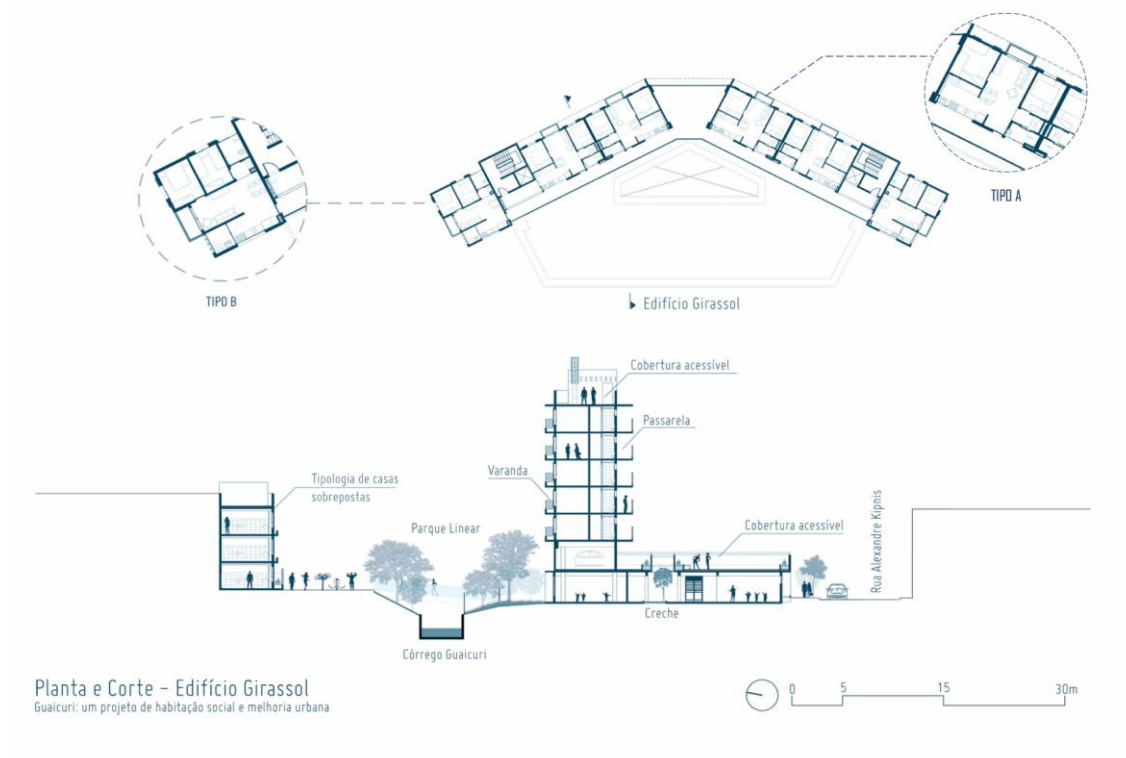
Planta do Pavimento Tipo e detalhe de unidades habitacionais “Tipo A” e “Tipo B” do Edifício Girassol (acima); Corte esquemático (abaixo). Fonte: Acervo Casa Cidade Arquitetura e Urbanismo, 2023.
